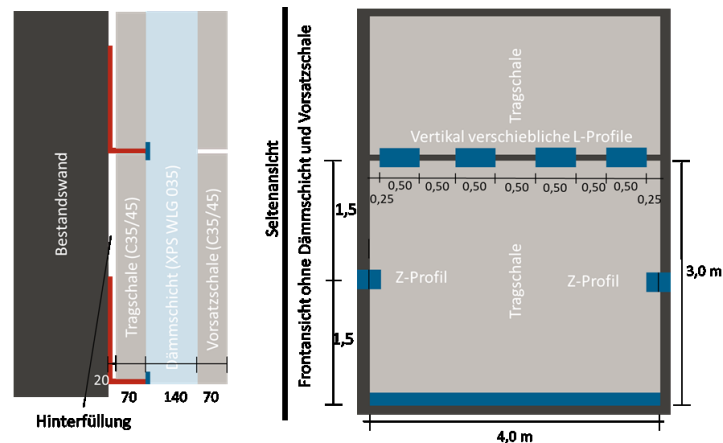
Anbringung eines Sandwichfassaden-Elements mit maximal möglichen Bauteilabmessungen
